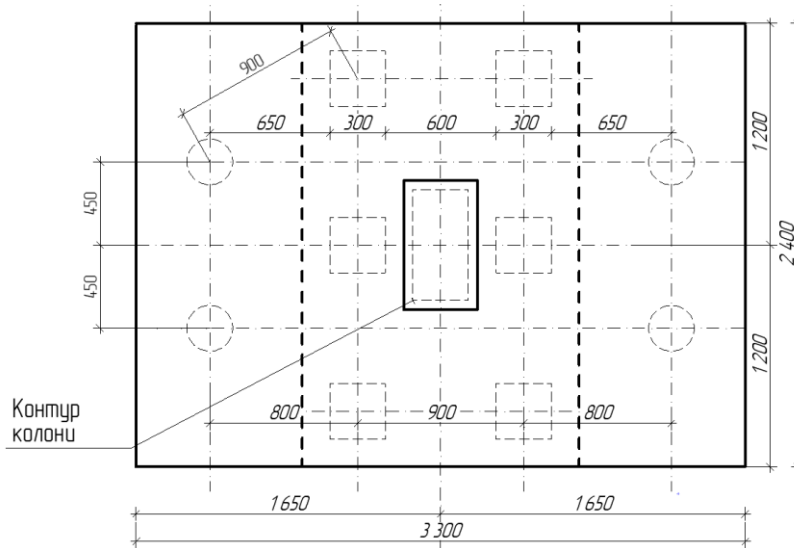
Розрахункова схема підсилення пального фундаменту влаштування буроін'єкційних паль.
